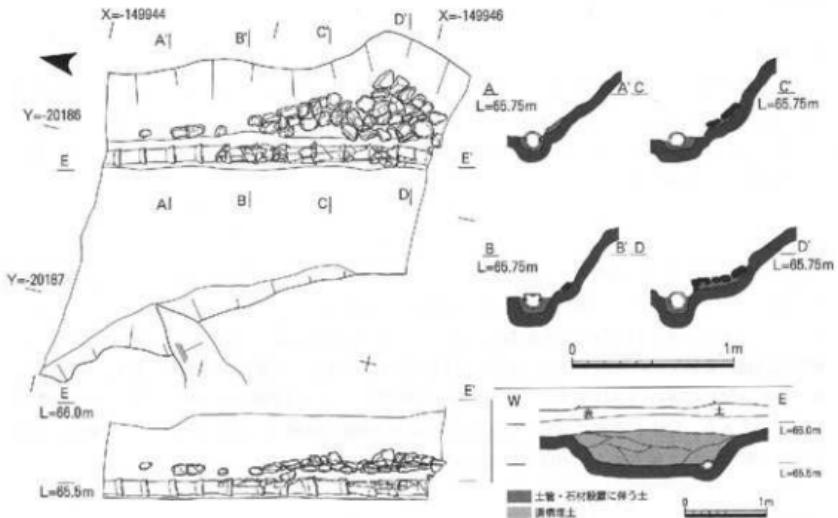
貼石連構平面図・立面図・断面図 (1/30) 崩断面図のみ1/60
